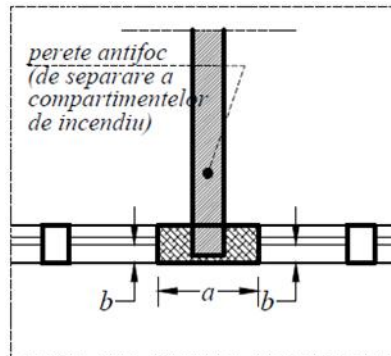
Превышение наружных плоскостей кровель и горючих стен
